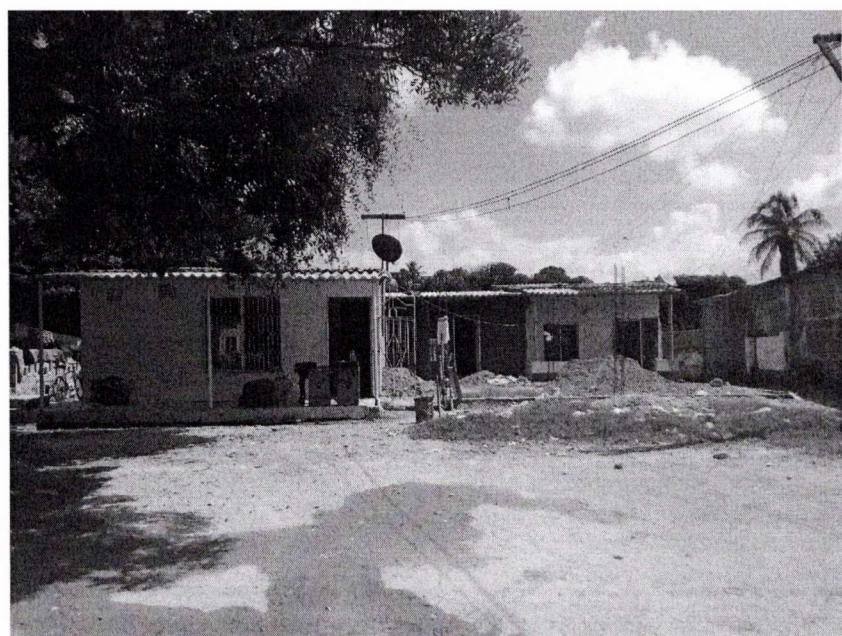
VIVIENDA Y CASA LOTE DONDE SE ESTA REALIZANDO LA CONSTRUCCION
